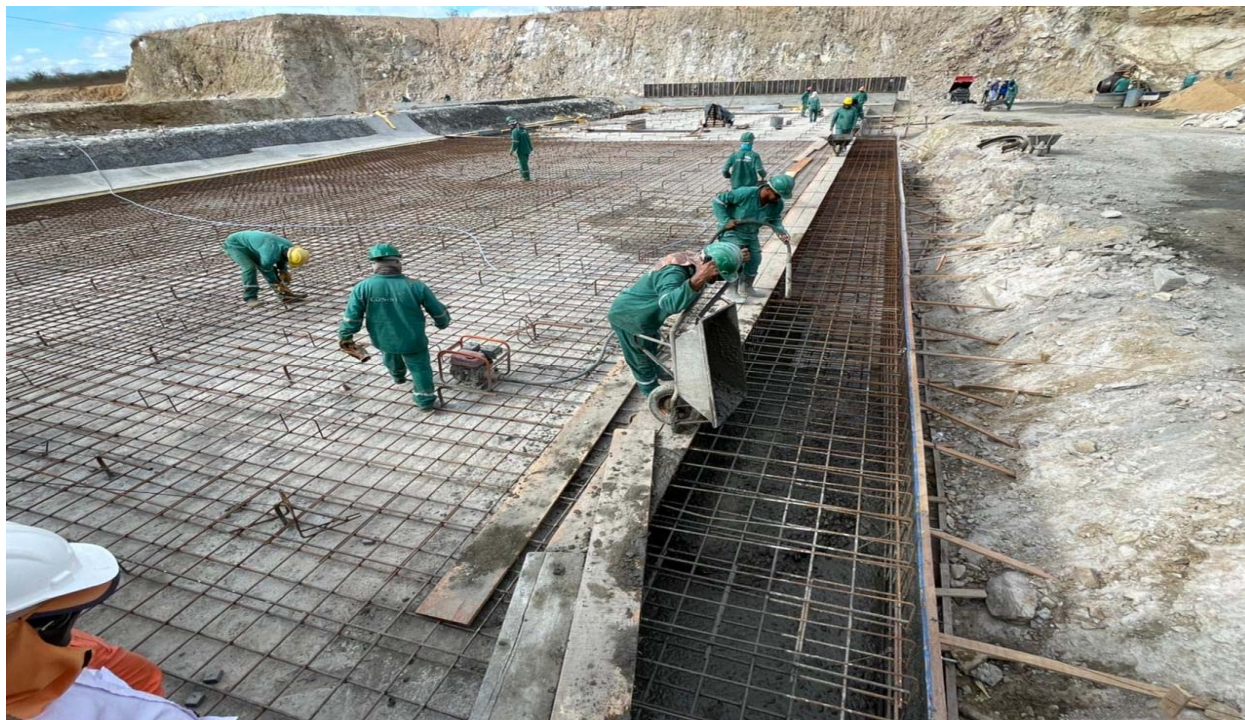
Concretagem do redente (laje da bacia de dissipação)
